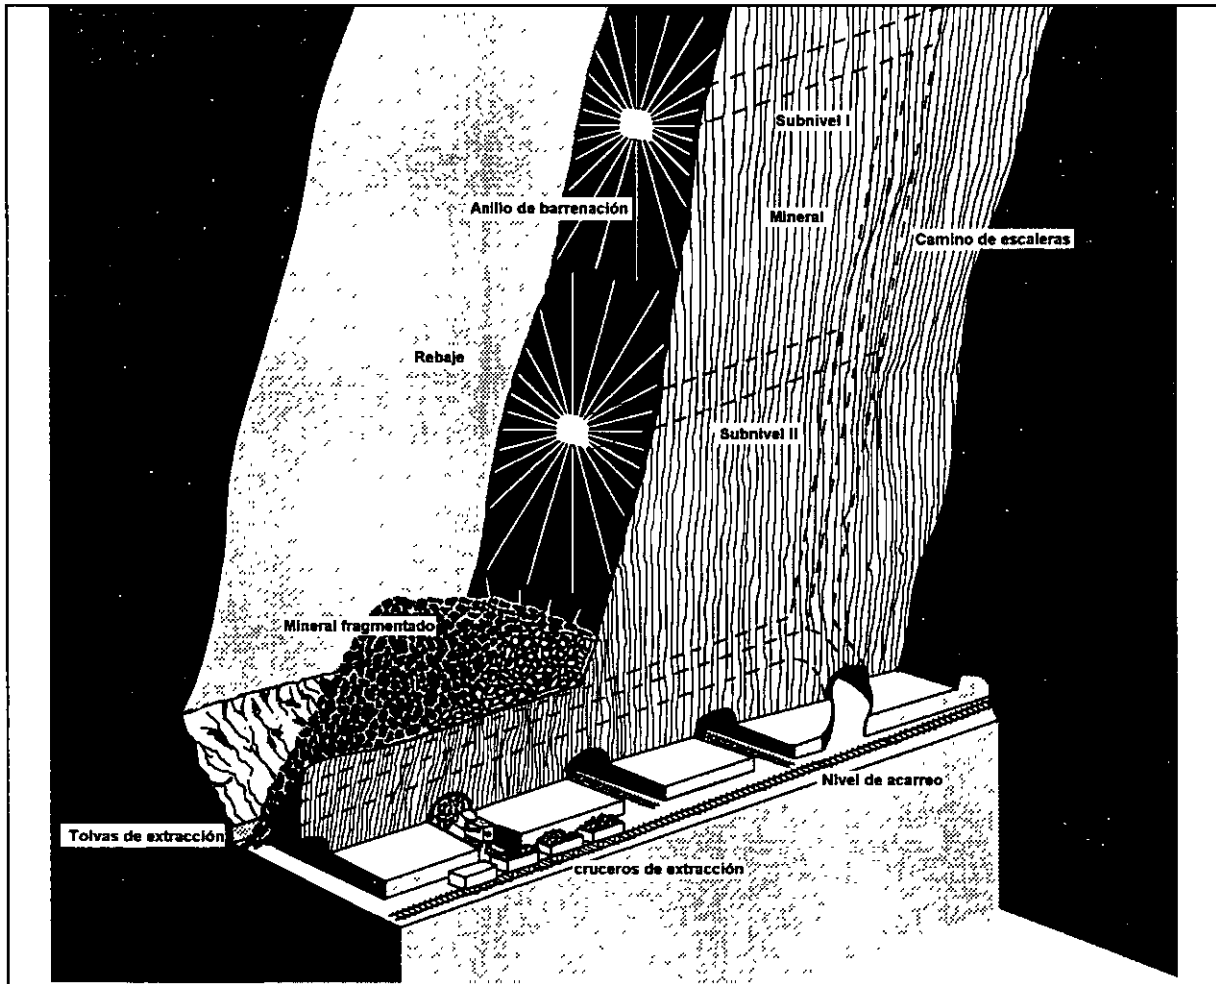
TUMBE POR SUBNIVELES USANDO ANILLOS DE BARRENACIÓN, EN VETAS ANGOSTAS CON REBAJES LONGITUDINALES
